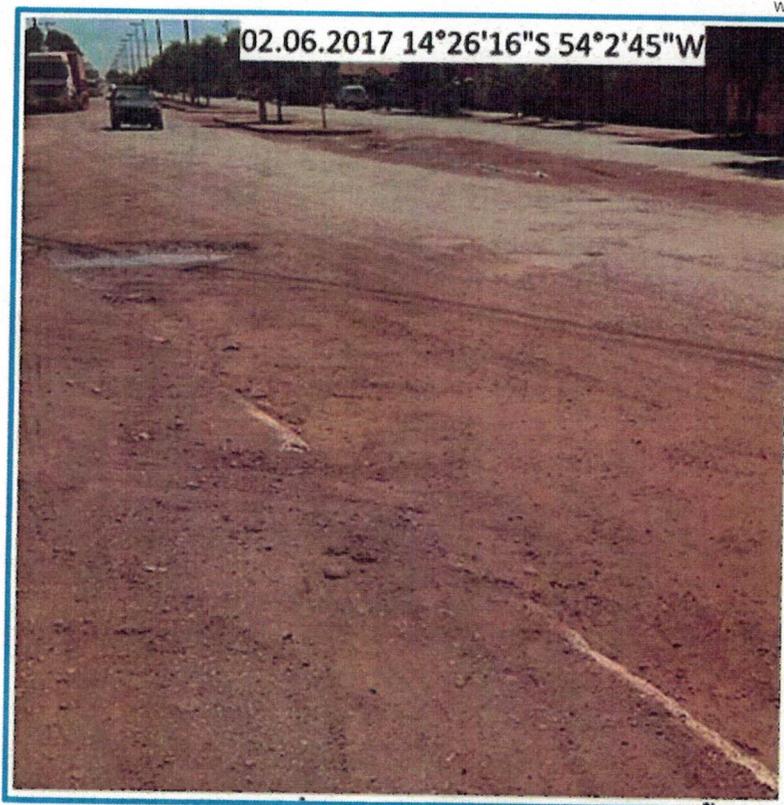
Rodovia MT-130 (Entrada do Bairro União)
